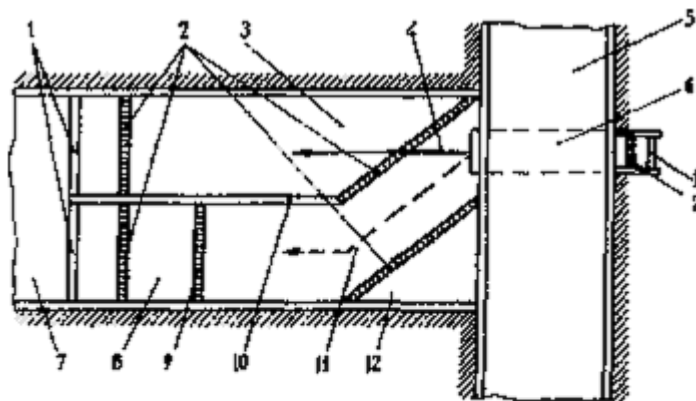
Схема двухлоткового рыбоуловителя: 1 - шандорное устройство; 2 - решетки; 3 - желоб для пропуска воды; 4 - направление основного потока воды; 5 - дамба; 6 - лежак (труба) под дамбой для сброса воды и выхода рыбы; 7 - сбросной канал; 8 - место для установки рыбоперегрузателя с каплером; 9 - подвижная решетка для концентрации рыбы; 10 - перегородивающая стенка между лотком-рыбонакопителем и желобом; 11 - направление выходящей рыбы; 12 - садок для передержки рыбы
